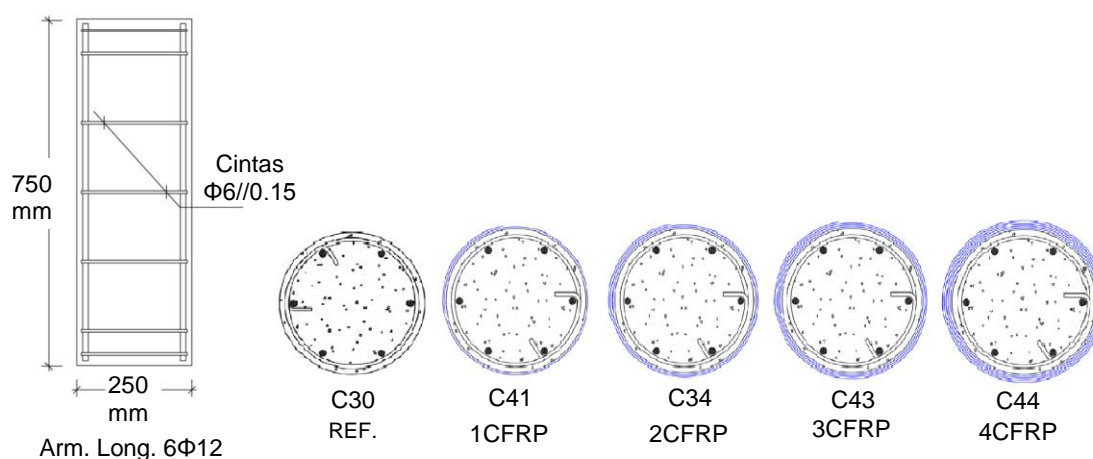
Pormenorização longitudinal e transversal das colunas (adaptado de Chastre [9])
